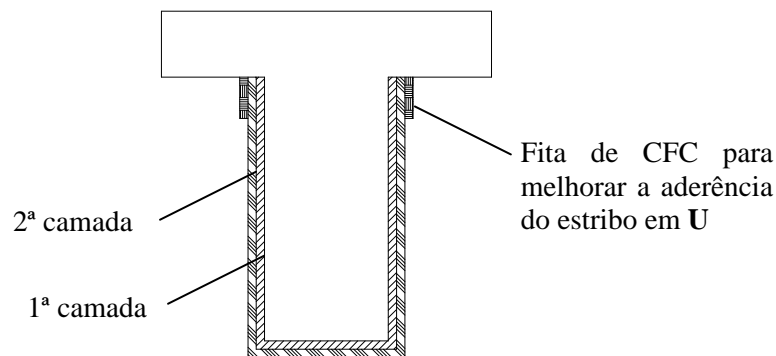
Seção transversal AA' das vigas reforçadas VI-2 e VII-2.
